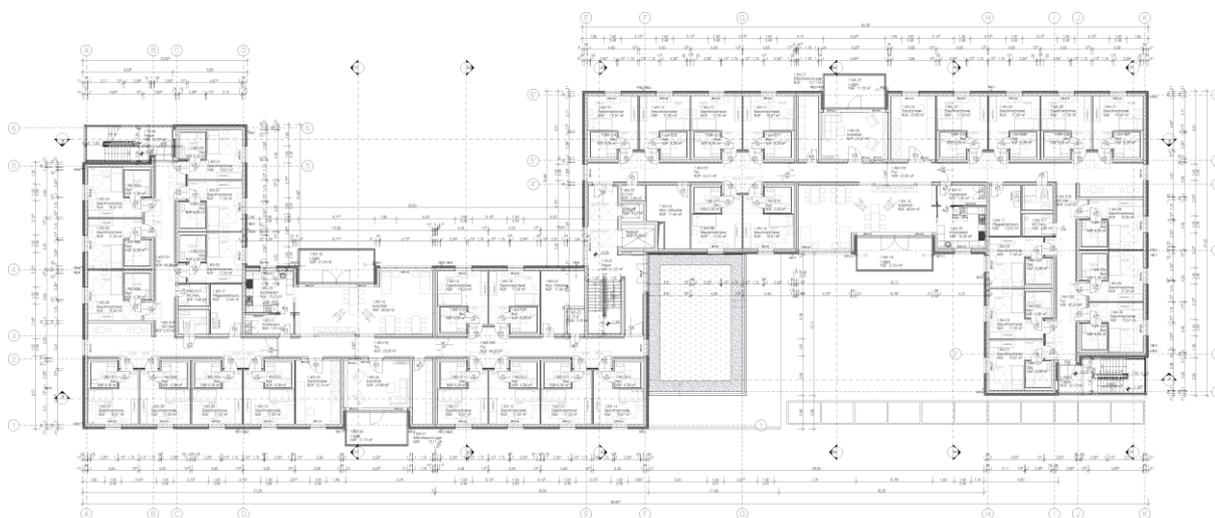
Grundriss I. OG _ Seniorenzentrum_HWR
